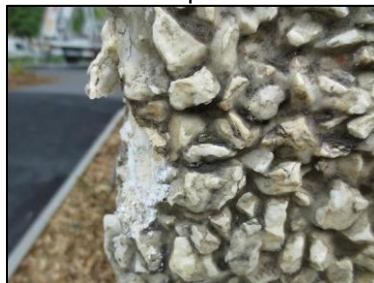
ECH-N°27 -BAT113-157 pignons Murs béton+pierres
